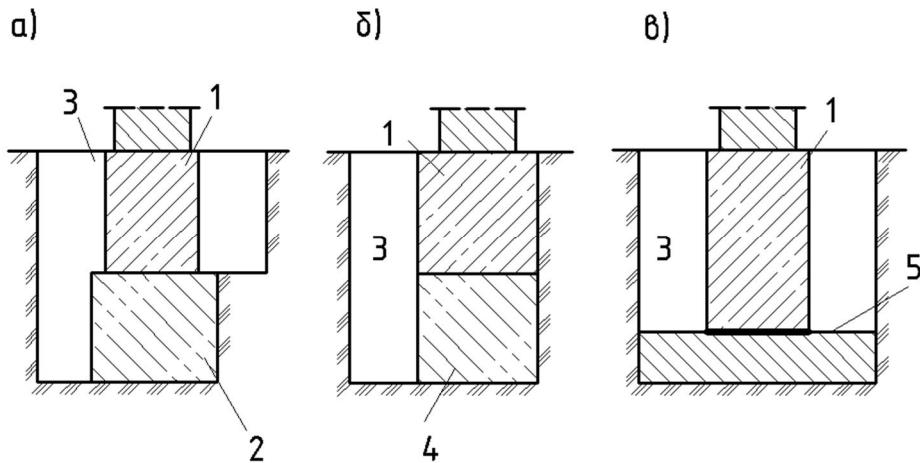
Усиление ленточных фундаментов опорными конструкциями:
